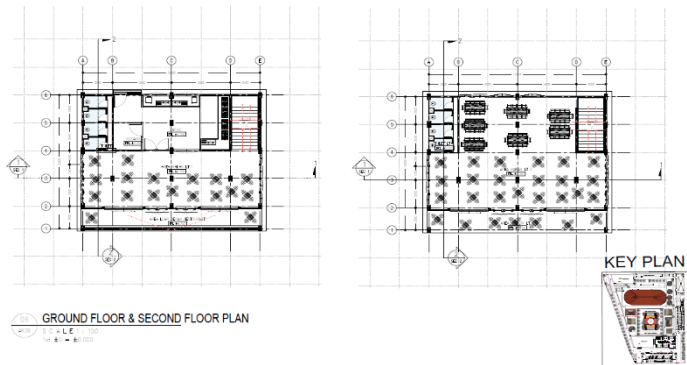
Denah Lantai 1, 2, 3 Auditorium
